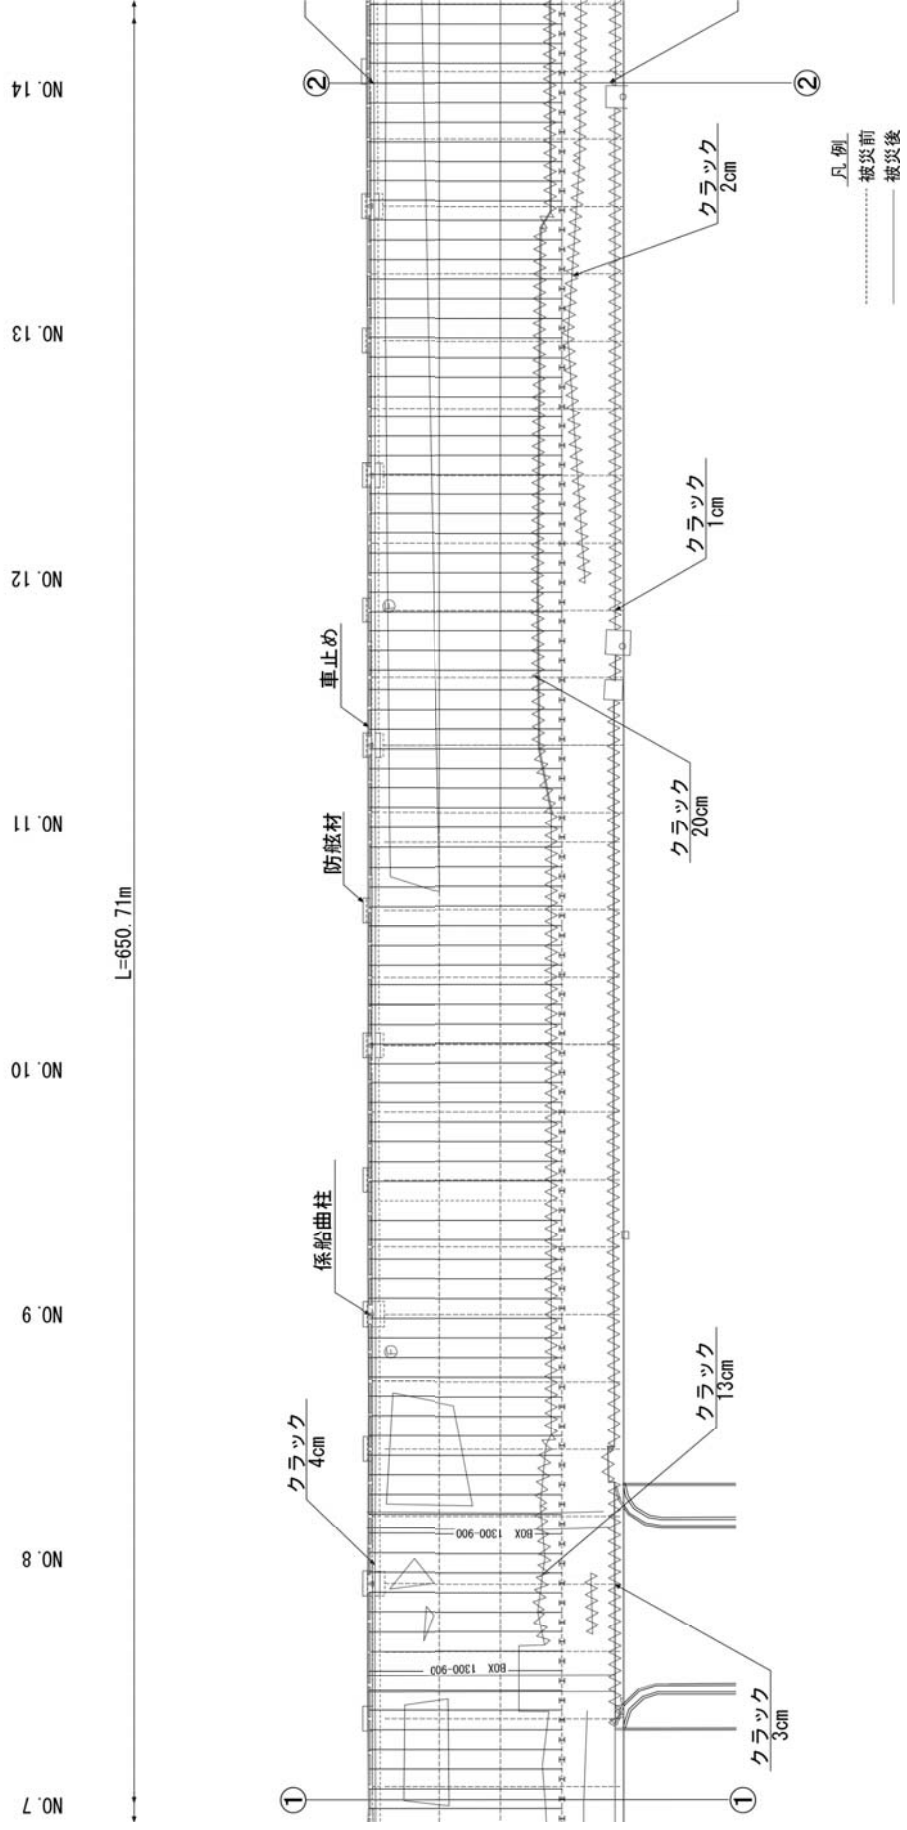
(b) 箱崎埠頭-7.5m 岸壁の被災状況詳細平面図
